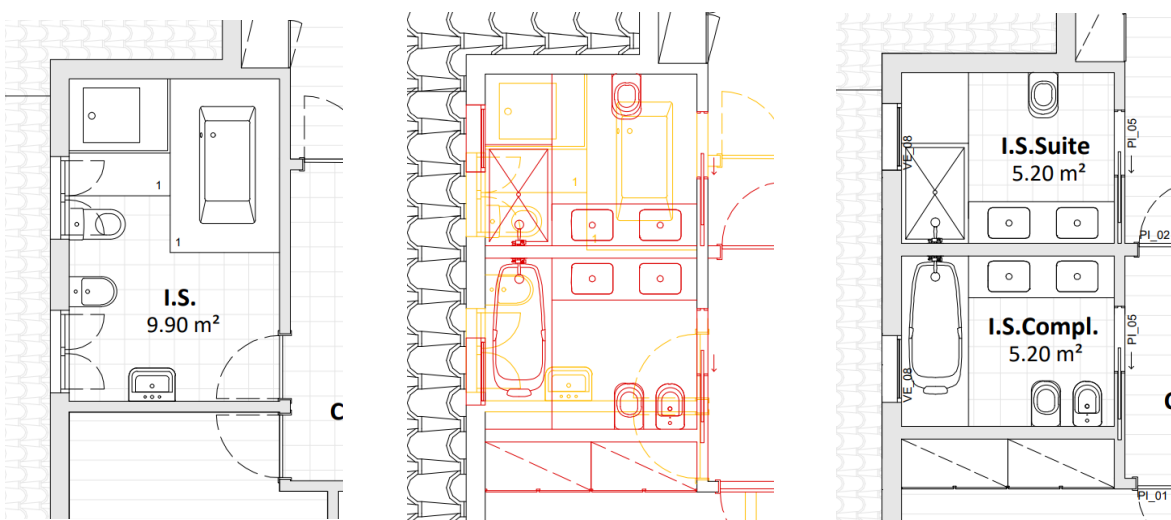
Excerto da planta das instalações sanitárias do piso 1 (LIC_R00). Fonte: Garq / Desenvolvimento: Autora.
